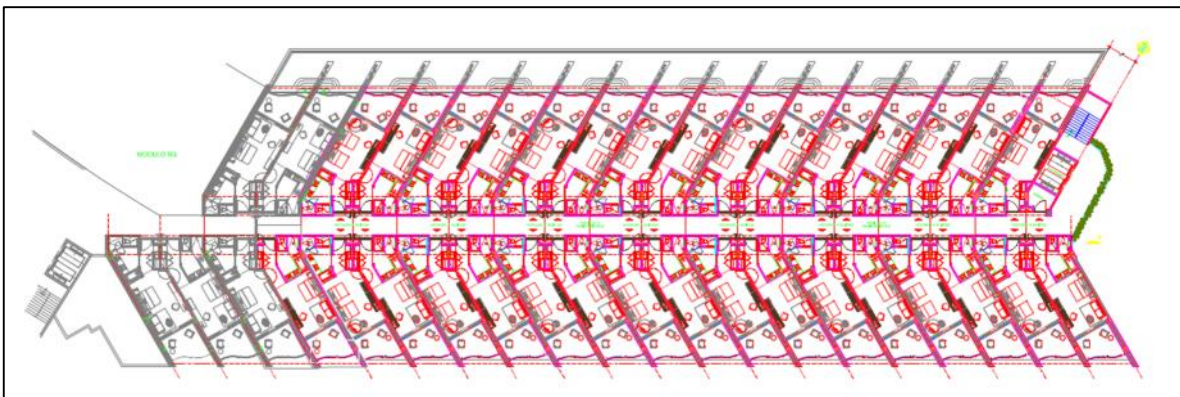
Edificio D, planta tipo (nivel 2, 3 y 4).
